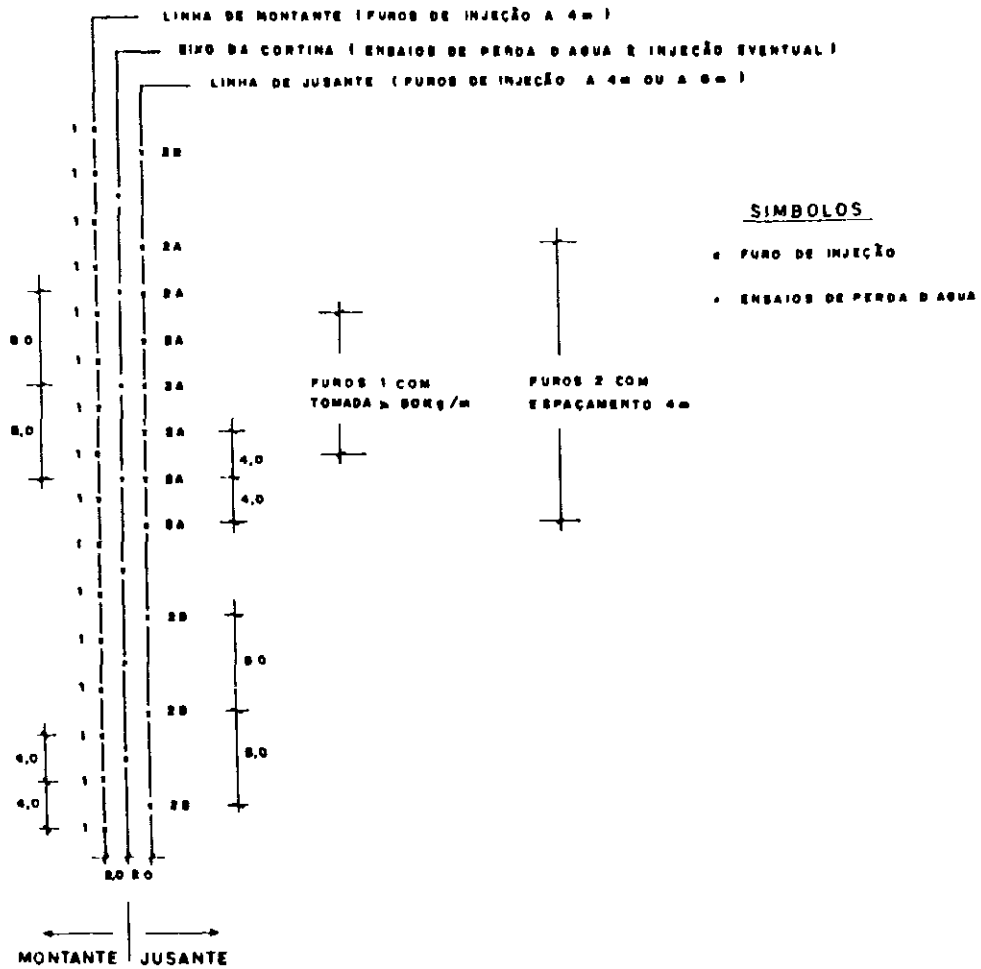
PLANTA ESQUEMÁTICA DA CORTINA DE INJEÇÕES.
